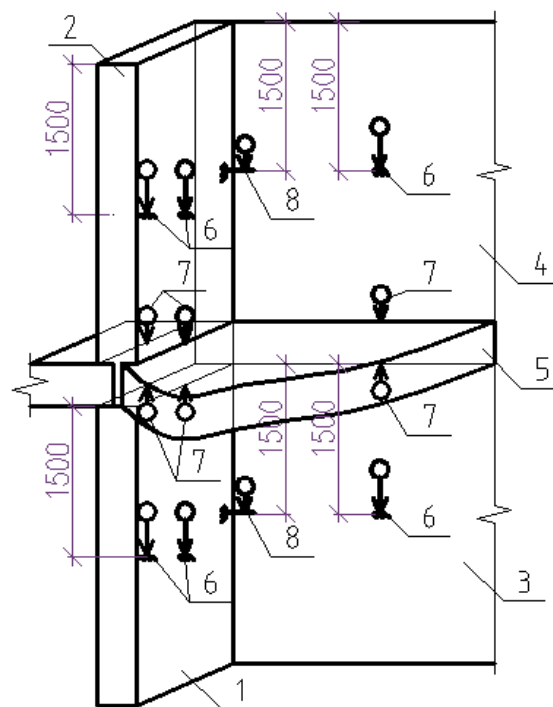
Схема расположения индикаторов. 1 – внутренняя несущая стеновая панель цокольного этажа; 2 – то же первого этажа; 3 – наружная
